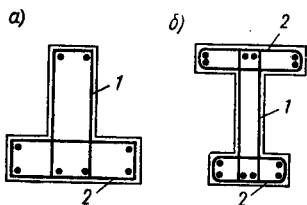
Армирование элементов, работающих на изгиб с кручением
